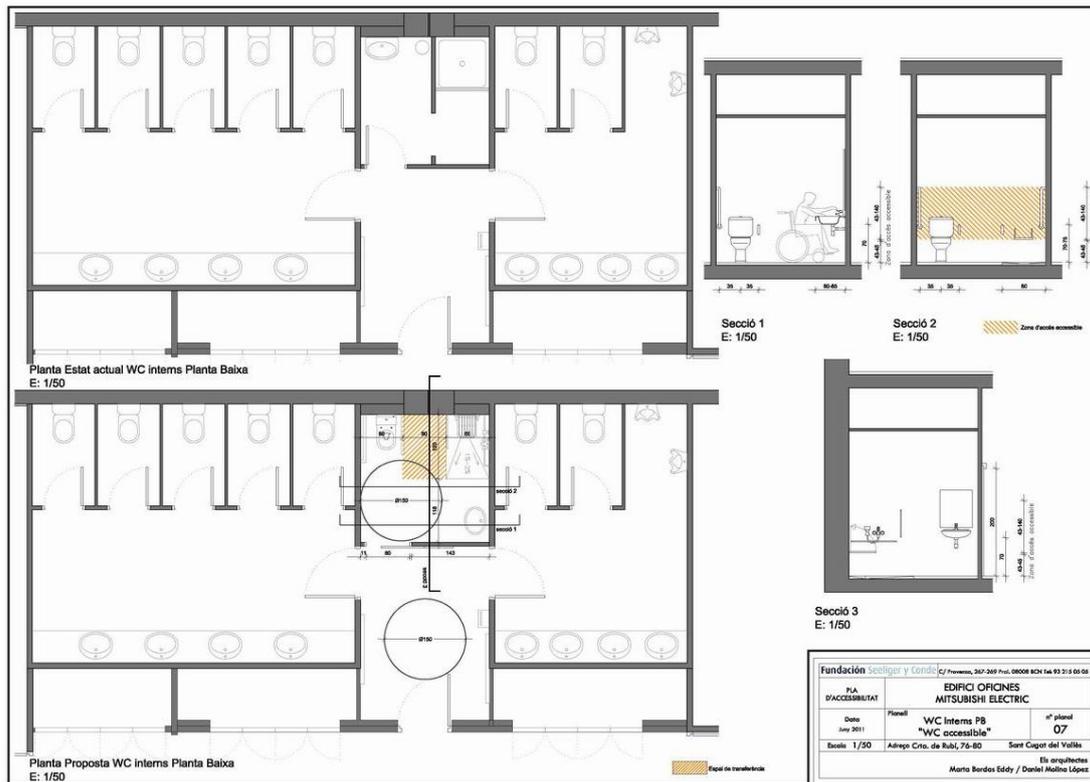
Edificio Oficinas MITSUBISHI ELECTRIC. Planta estado actual y propuesta nueva baños internos 1 de Planta Baja.
